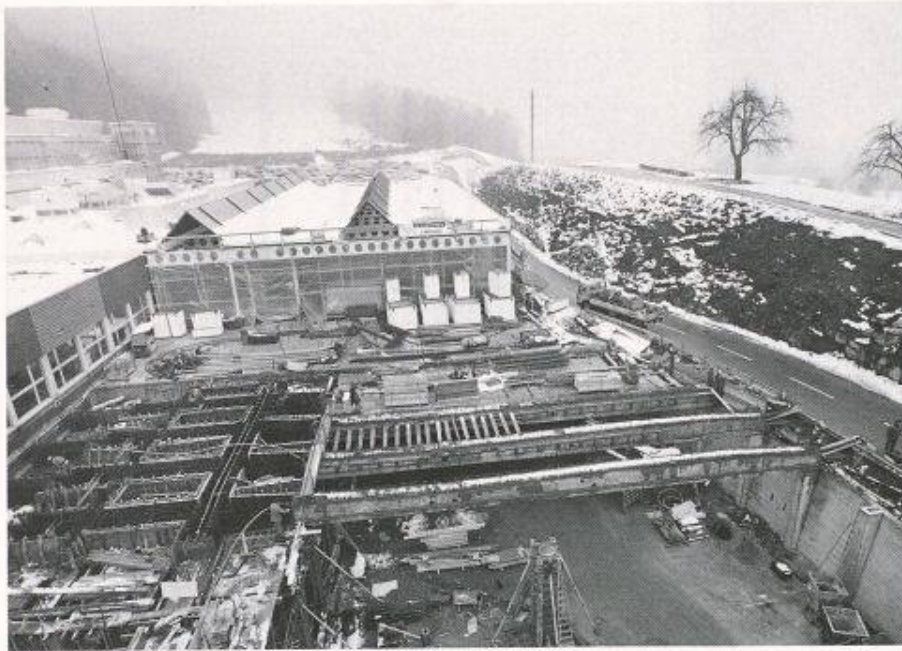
Baustelle mit bereits versetzten Fertigteilträgern
